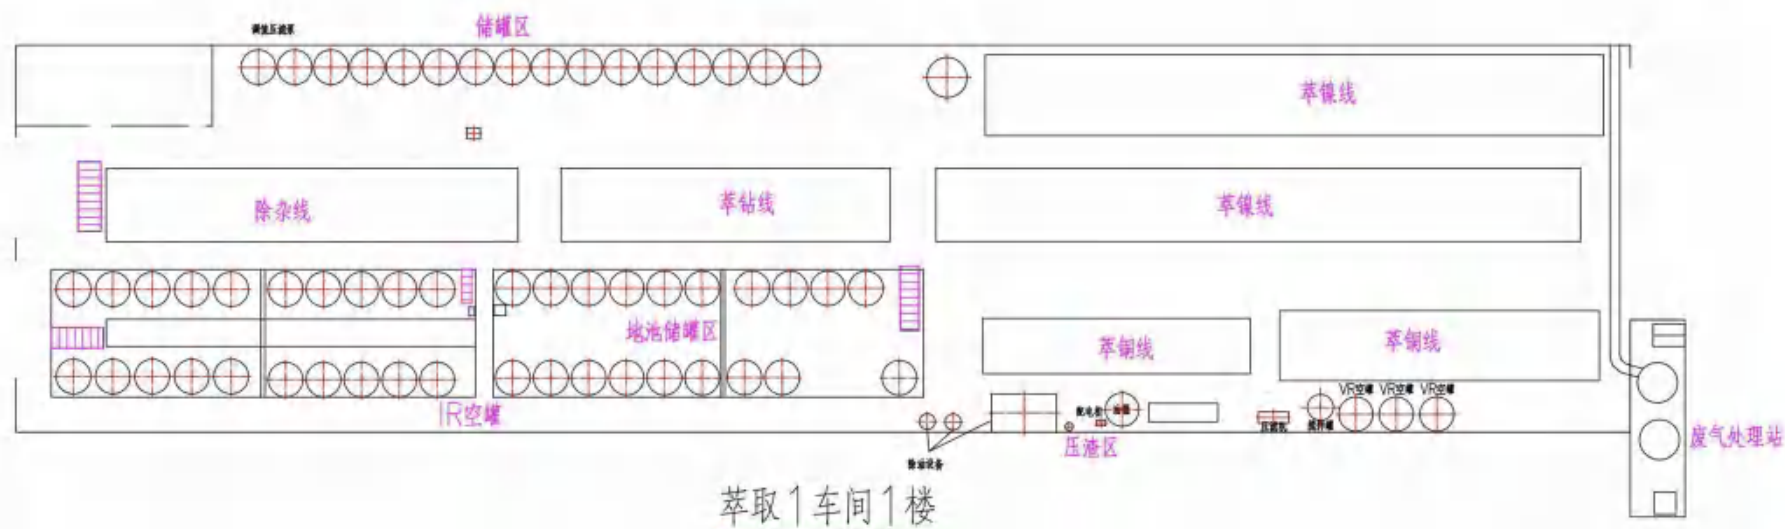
萃取一车间设备设施平面布置图 (1 楼)
